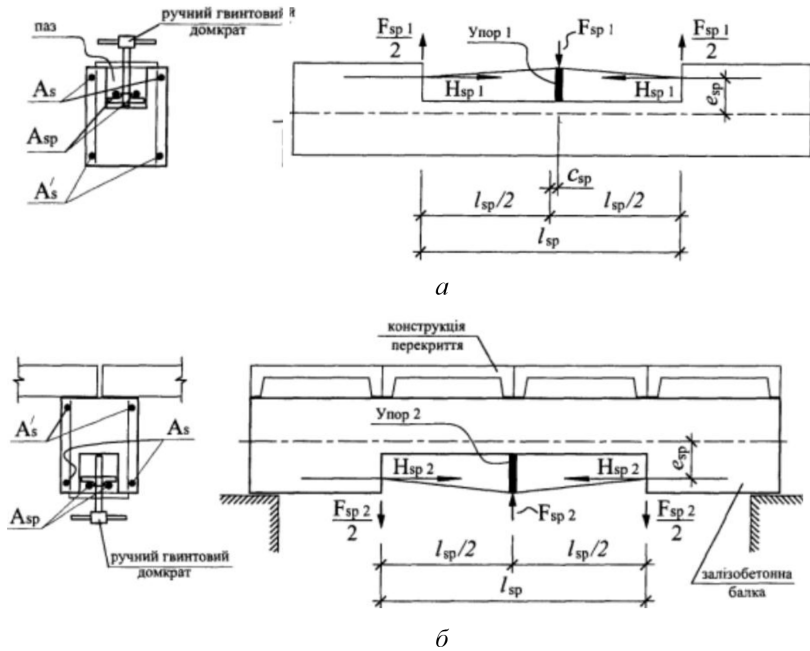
Спосіб виготовлення локально попередньо напружених збірних залізобетонних елементів: а) схема відтягування арматури ручним гвинтовим домкратом та розподіл зусиль під час виготовлення; б) схема відтягування арматури та схема зусиль після встановлення конструкції у проектне положення та часткового навантаження
